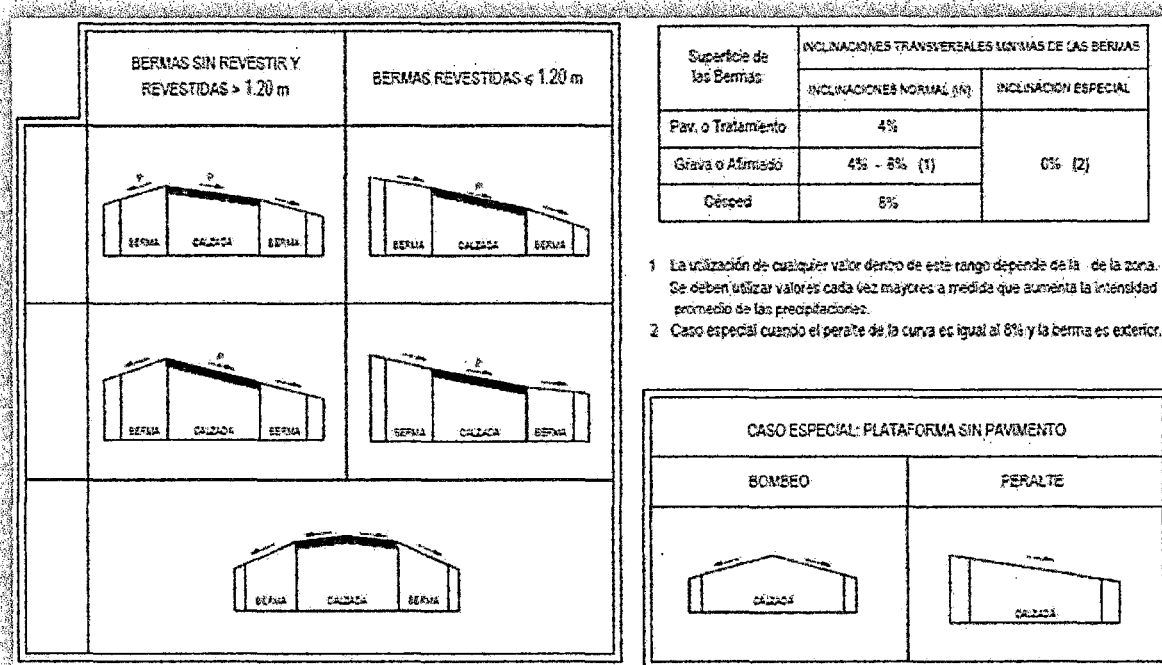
Inclinación transversal de bermas - Fuente[2]
